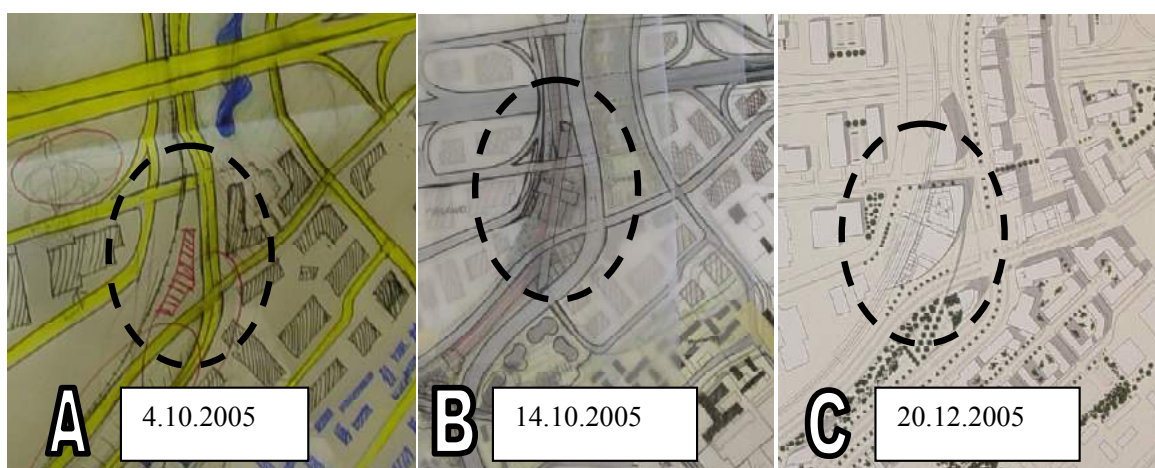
Phases dans la conception du plan d'une gare ferroviaire
